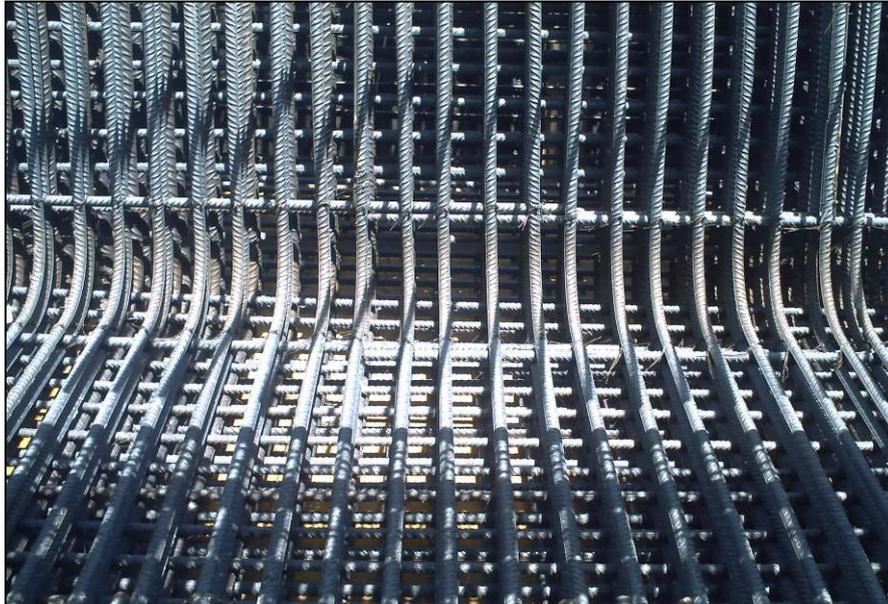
Central. Grupo 1. Aspecto da armadura na parte frontal da laje.
